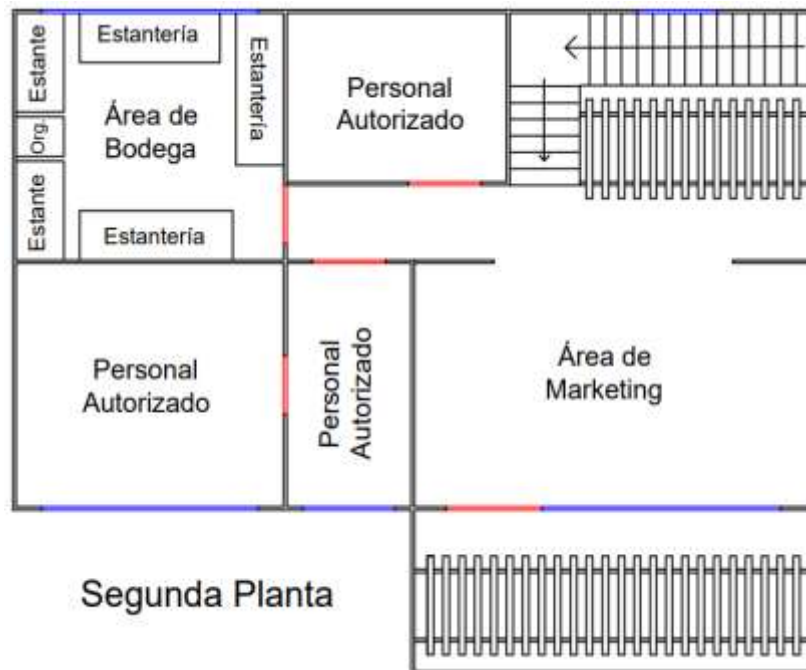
Layout segunda planta clínica SIRA PETS elaborado en AUTOCAD.
